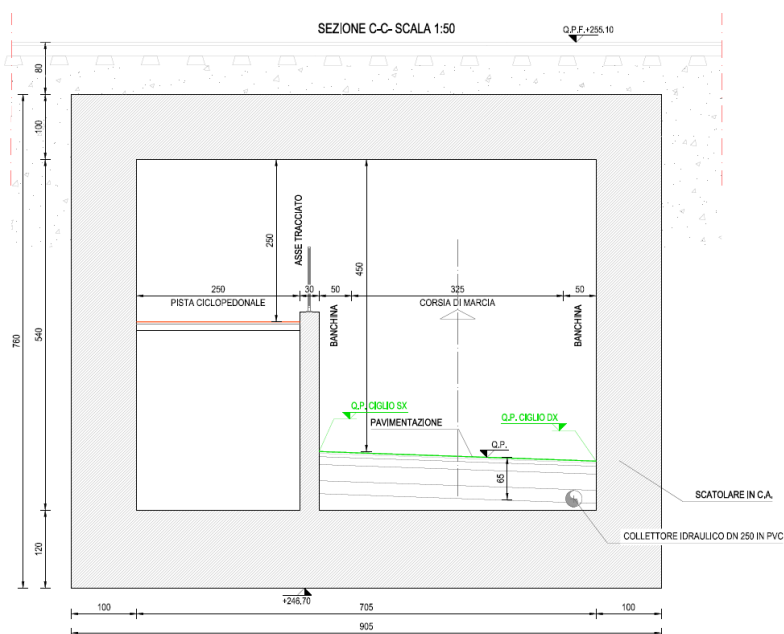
Sezione manufatto di progetto – Via XXIV Maggio
